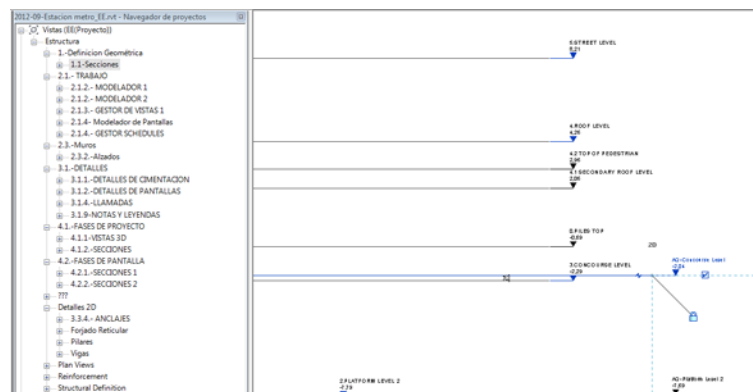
Vista de alzado de control de niveles. 2012. Euroestudios
